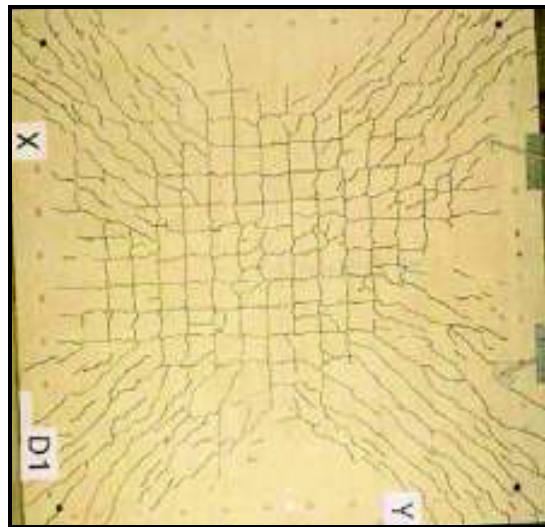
Fissuração de uma laje simplesmente apoiada. Fonte: Rochdi (2004).
